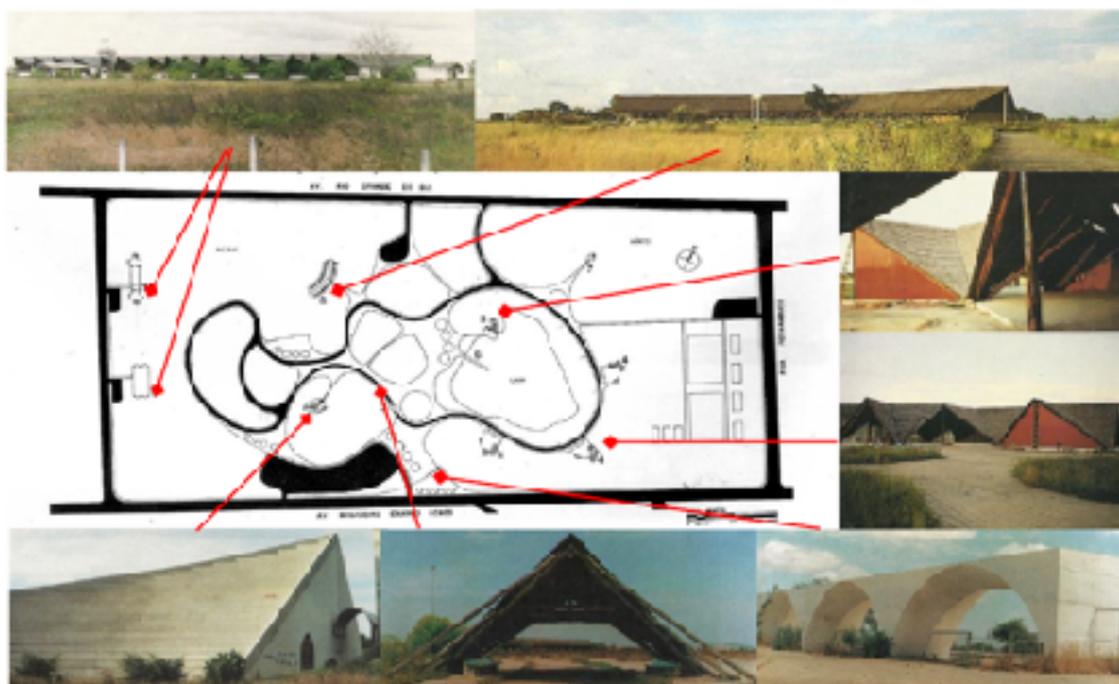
Planta de situação e principais equipamentos propostos no projeto.
